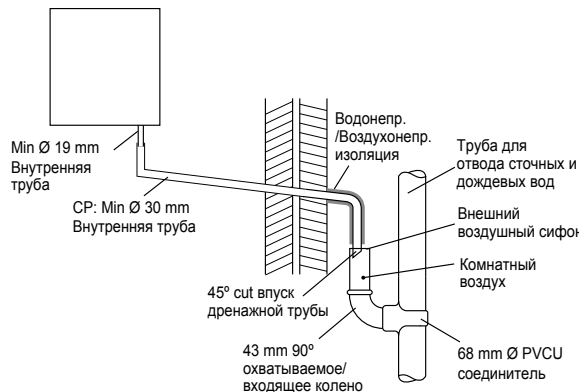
Подсоединение слива конденсата к дренажной и вентиляционной трубе
